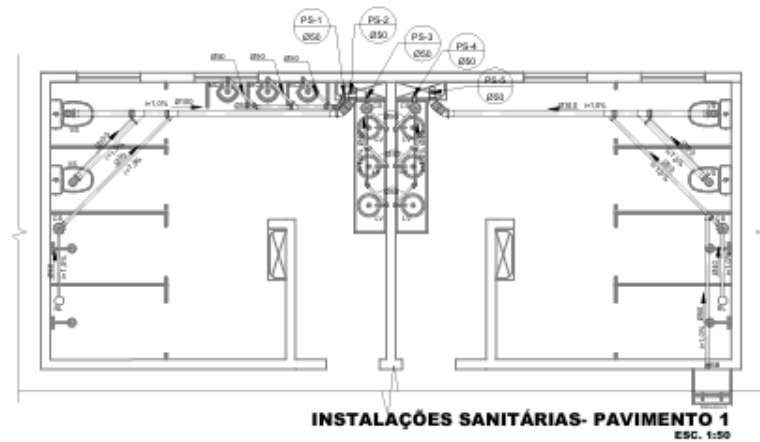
Instalações Hidrossanitárias do Pavimento 1
